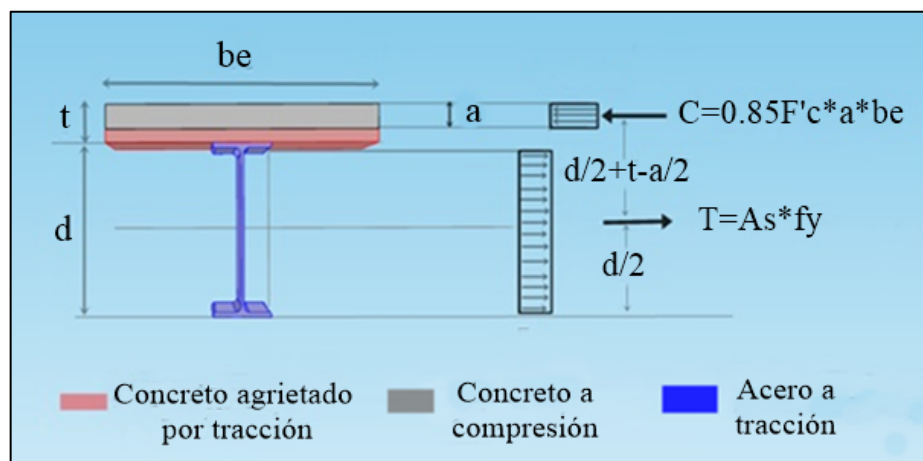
Distribución de esfuerzos plásticos (eje neutro dentro de la losa de concreto).
